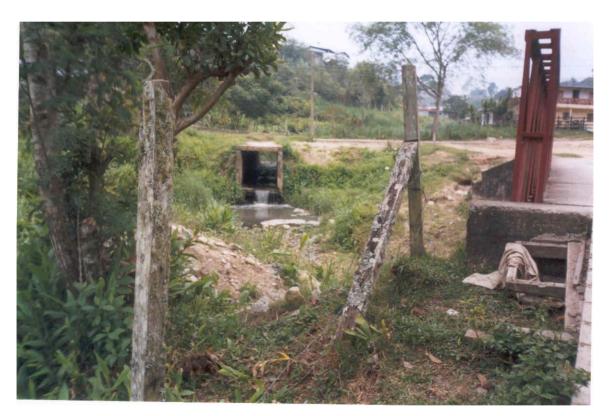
Estructura hidráulica (box coulvert) ubicado en el sector de la playita.
